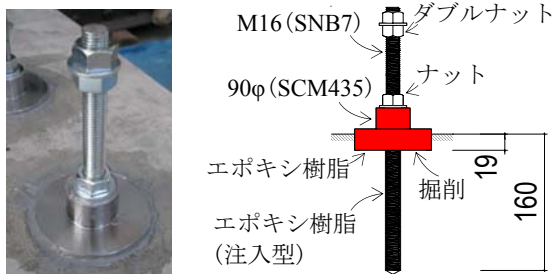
ディスク型アンカー 図-11 詳細図(単位:mm)
